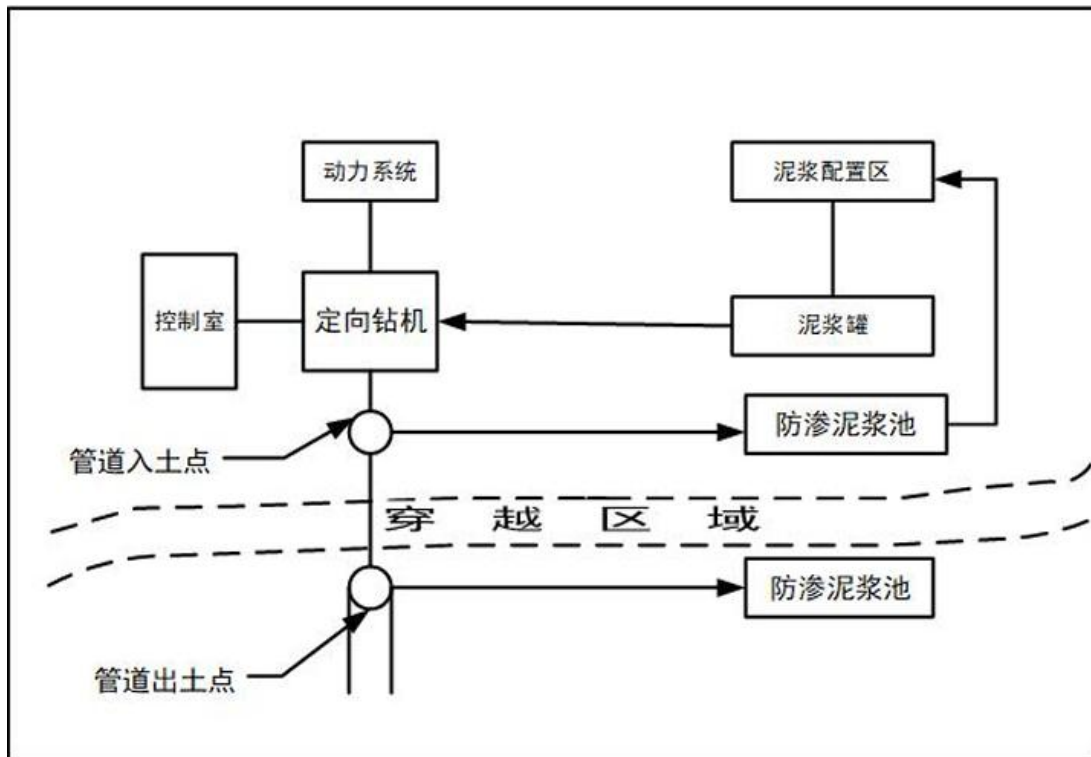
定向钻穿越施工作业场地平面布置示意图
